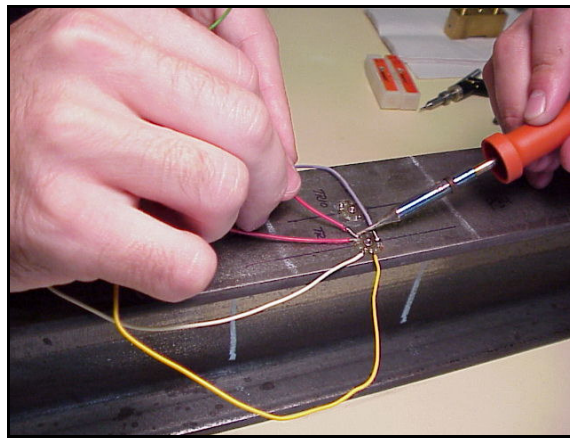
Operação de soldadura dos componentes de ligação.
